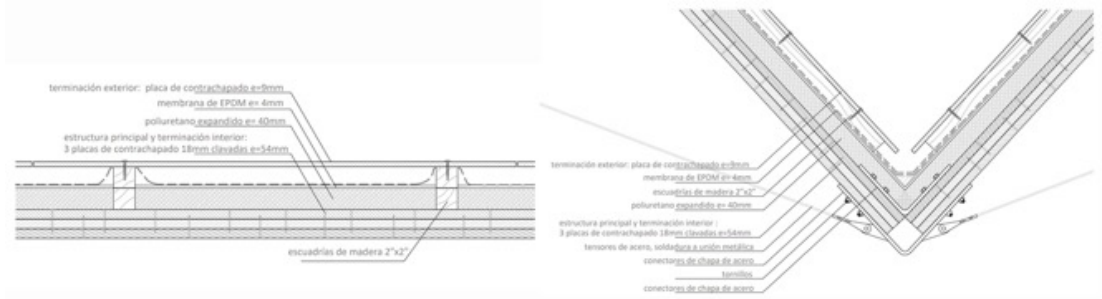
DETALLES CONSTRUCTIVOS DE LA CUBIERTA PLEGADA. A) SECCIÓN DE UN FALDÓN. B) SECCIÓN DE UNA LIMAHOYA.
